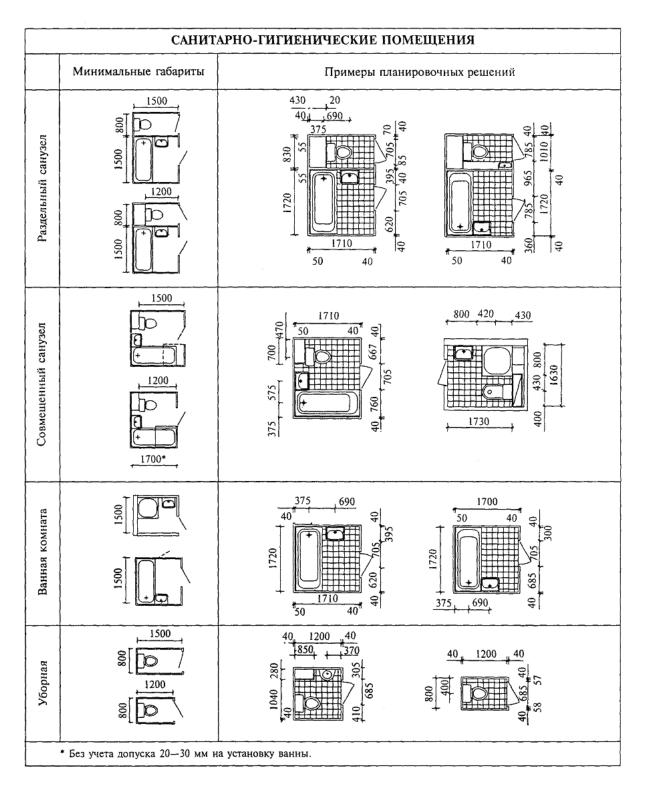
Минимальные габариты и площади помещений квартиры
